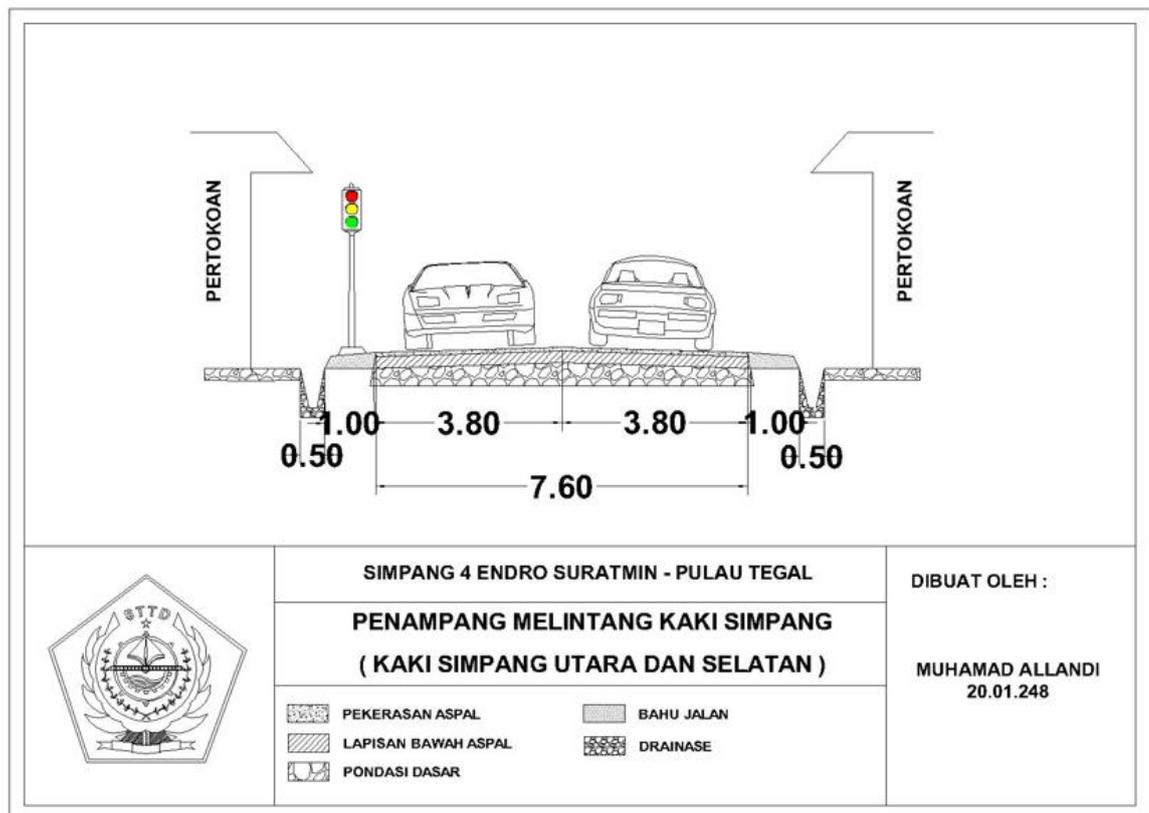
Layout Simpang 4 Endro Suratmin – Pulau Tegal
